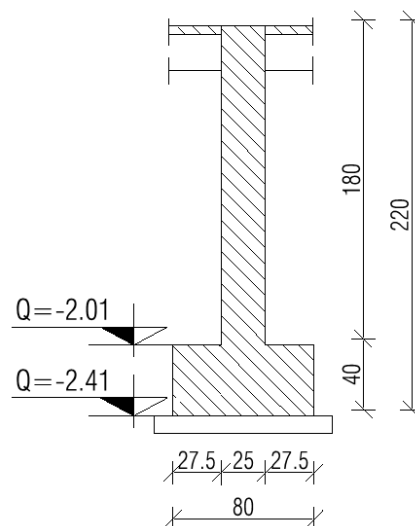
Sezione tipo Fondazioni Edificio A1-A2
